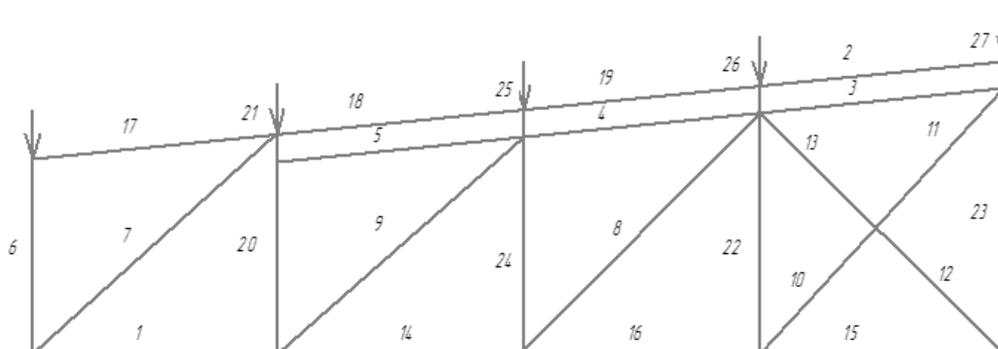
Расчетная схема половины фермы до реконструкции (указаны номера стержней).
